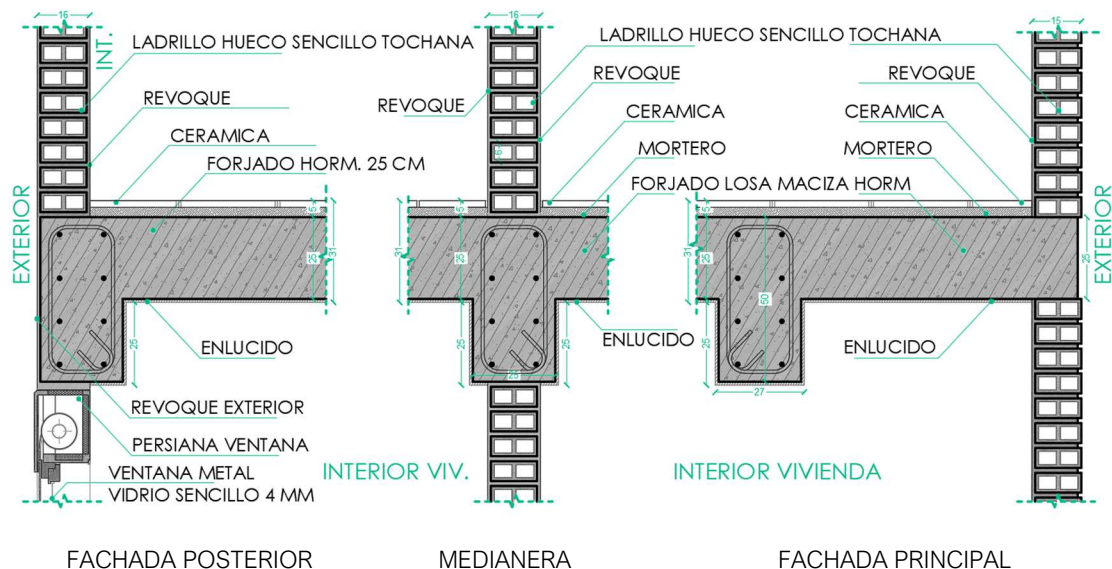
Detalle constructivo de muros. Elaboración propia.
